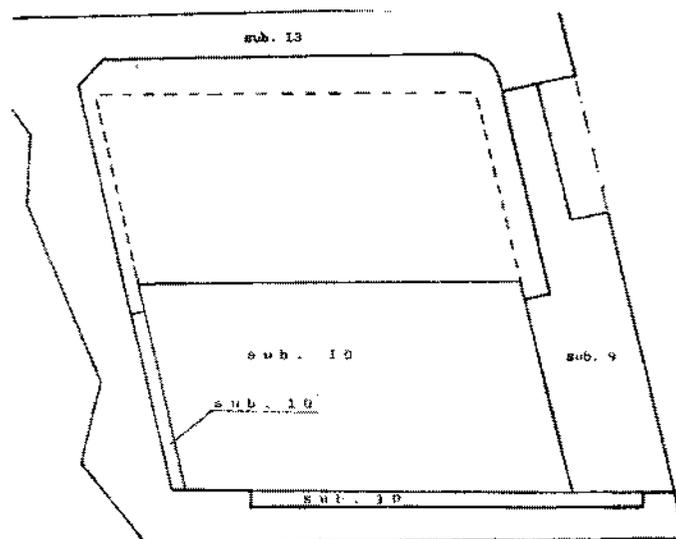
Rappresentazione subaltrni 9,10 (Elaborato Planimetrico catastale)
